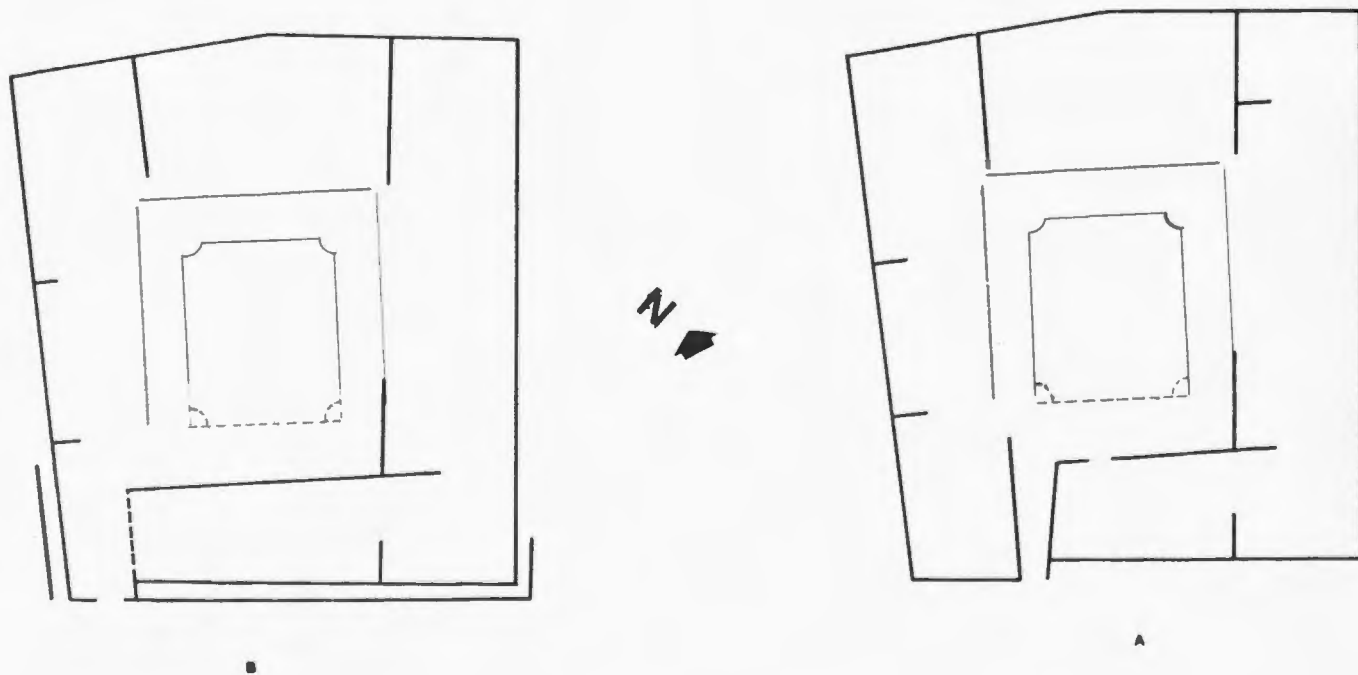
Croquis-planta de la vivienda: a) estado actual, b) hipotético trazado del acceso
